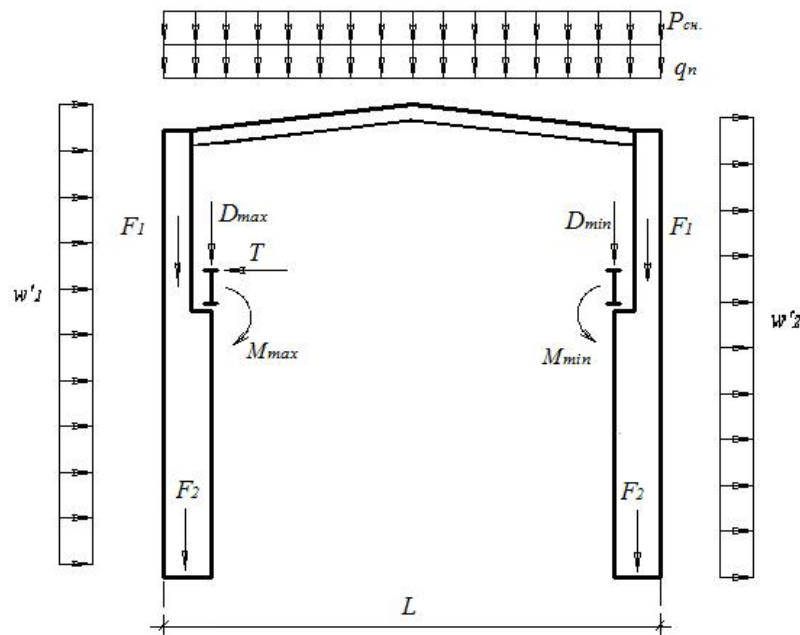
Нагрузки, приведенные к расчетной схеме
